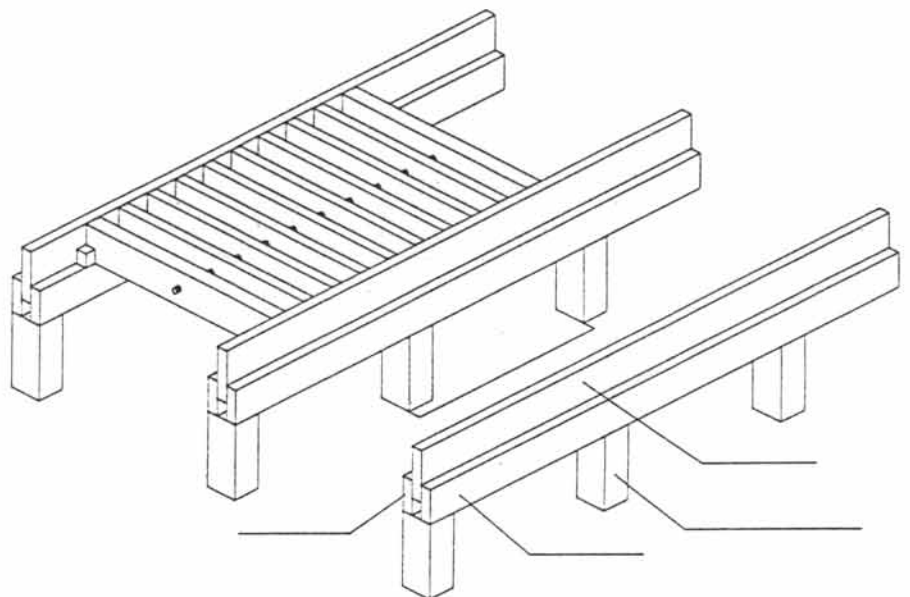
Détails de construction d'une grille permettant le passage au tracteur. La grille se compose de lattes de 40 x 100 mm, longues de 720 mm; l'espace réservé au passage de l'air s'élève à 80 mm. Un tube d'acier de 20 mm de diamètre assure que les lattes ne basculent pas sous le poids du tracteur.
